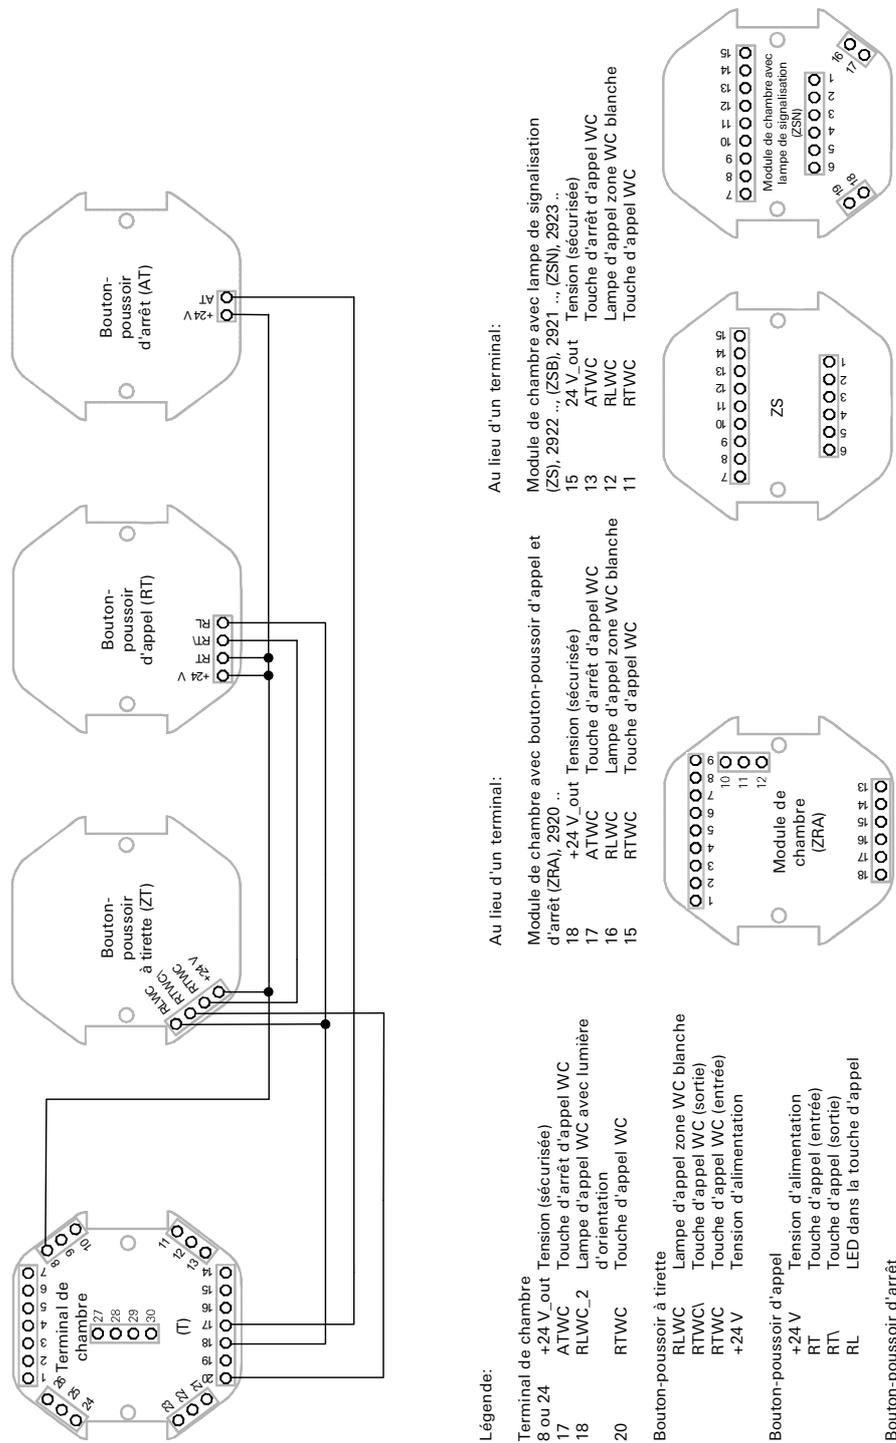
Exemple de câblage d'une salle d'eau avec bouton-poussoir à tirette, bouton-poussoir d'appel et bouton d'arrêt
